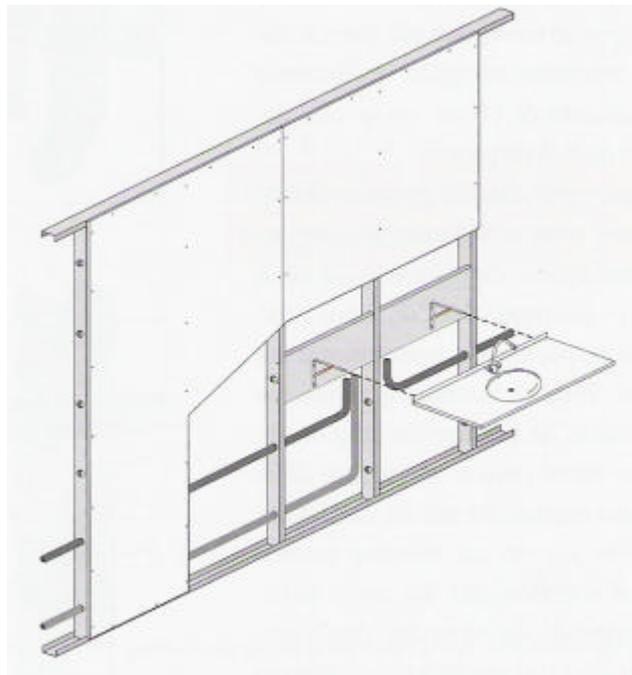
Reforço para instalação de bancada em divisória *drywall*. Fonte: Abragesso, 2004.
